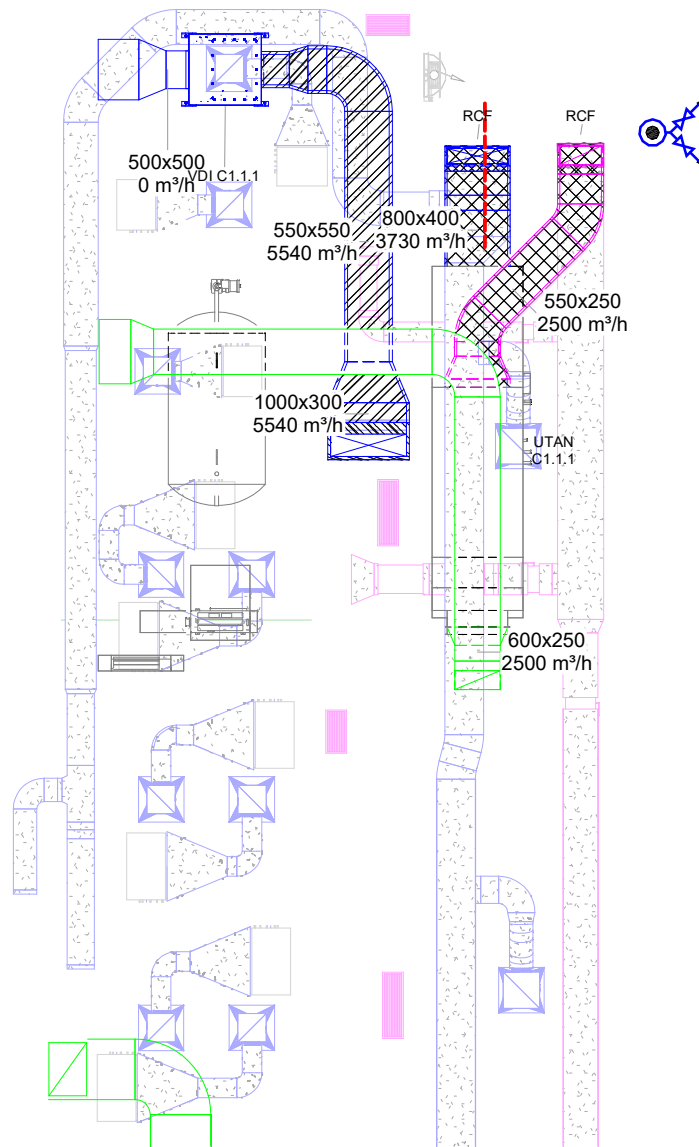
Seção 2.3 da planta geral do traçado das condutas na *mezzanine* à escala 1:100.
